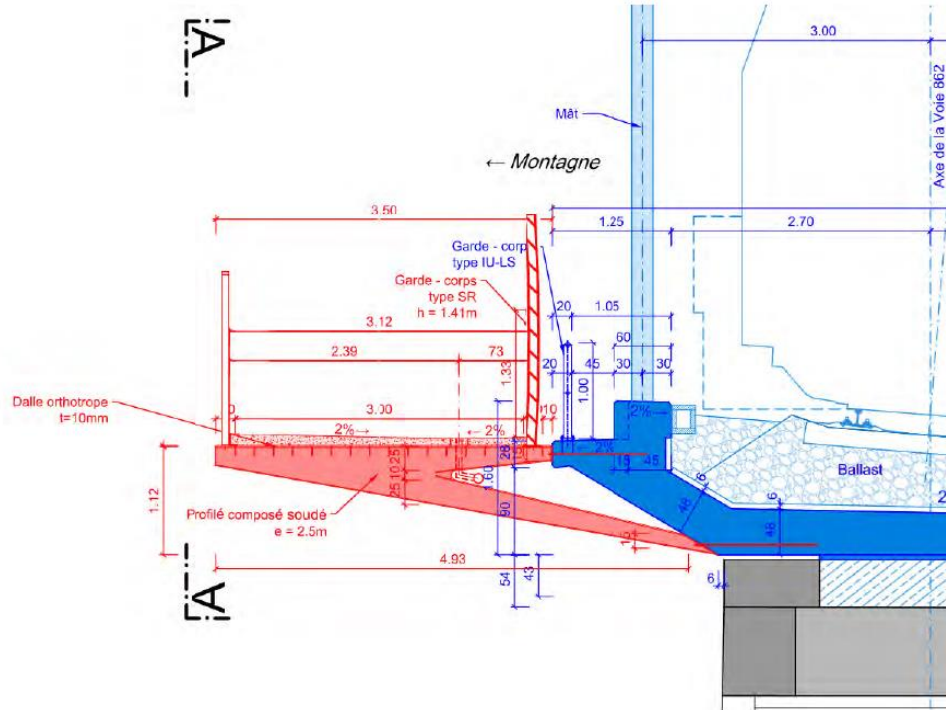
coupe de la passerelle fixée à l'auge en béton du viaduc. © Gruner, 2024
